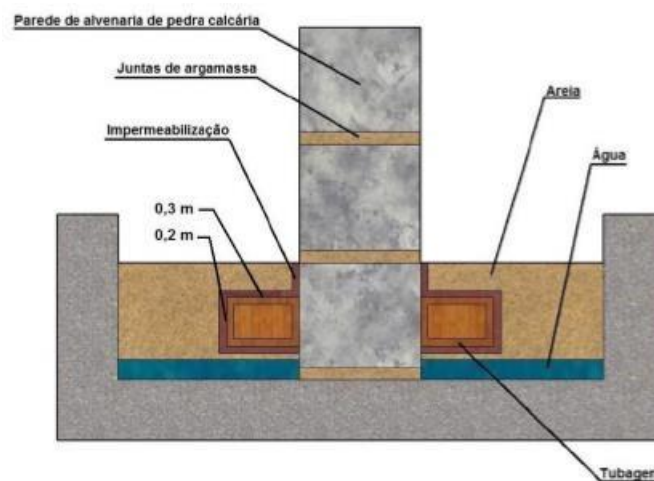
Configuração 2C – Impermeabilização do sistema de ventilação a envolver todas as faces do canal de ventilação com exceção da face que contacta com a parede [13]
